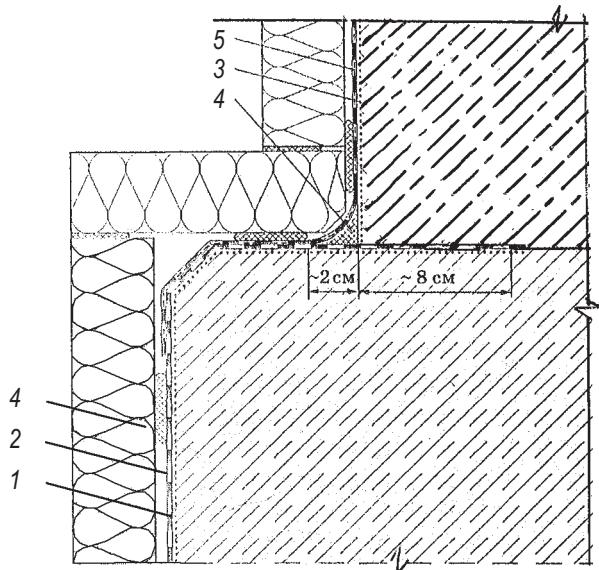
Стикування вертикальної гідроізоляції стіни з гідроізоляцією фундаментної плити:
